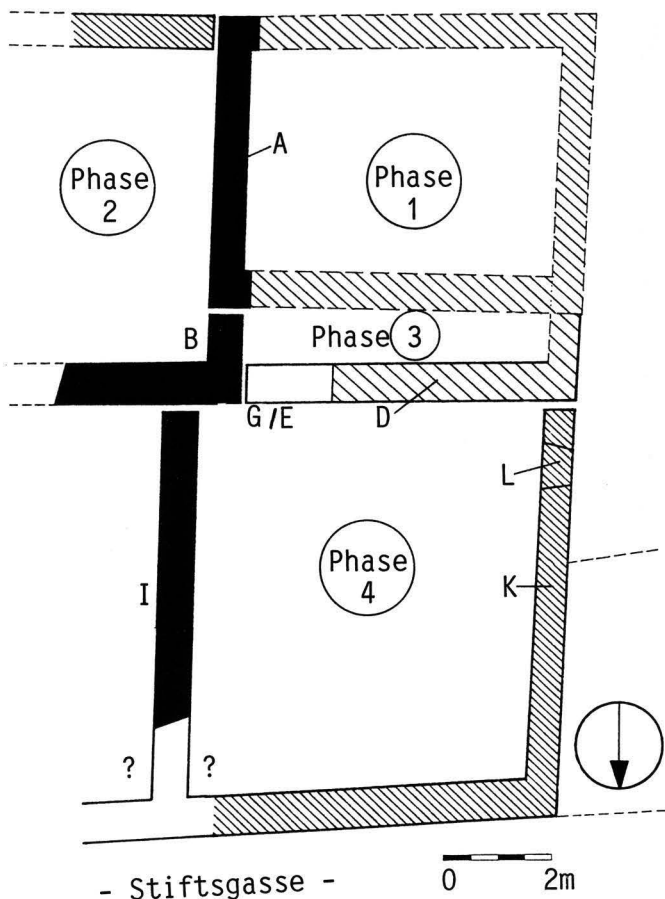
Stiftsgasse 5. Grundriss des Erdgeschosses. Schwarz: Mauerverlauf gesichert, schraffiert: Mauerverlauf wahrscheinlich. – Zeichnung: St. Tramèr.
